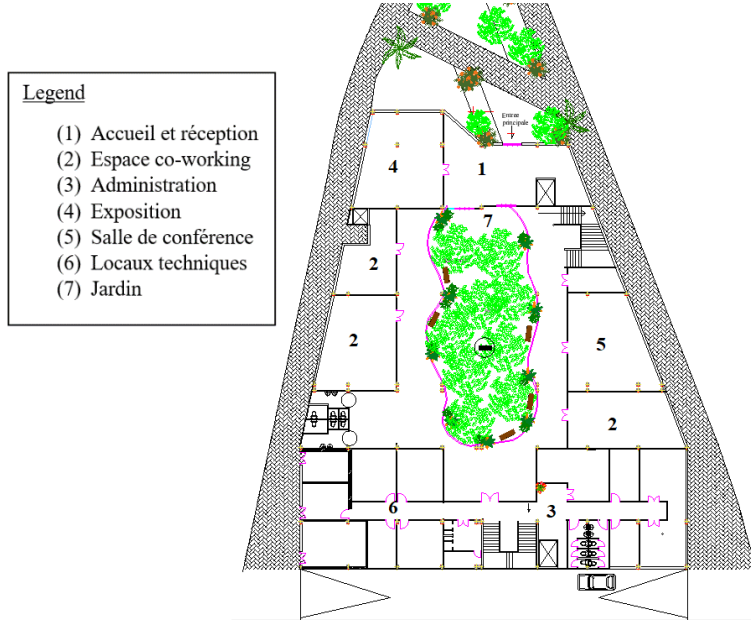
Plan rez-de-chaussée, Source : Auteurs.
